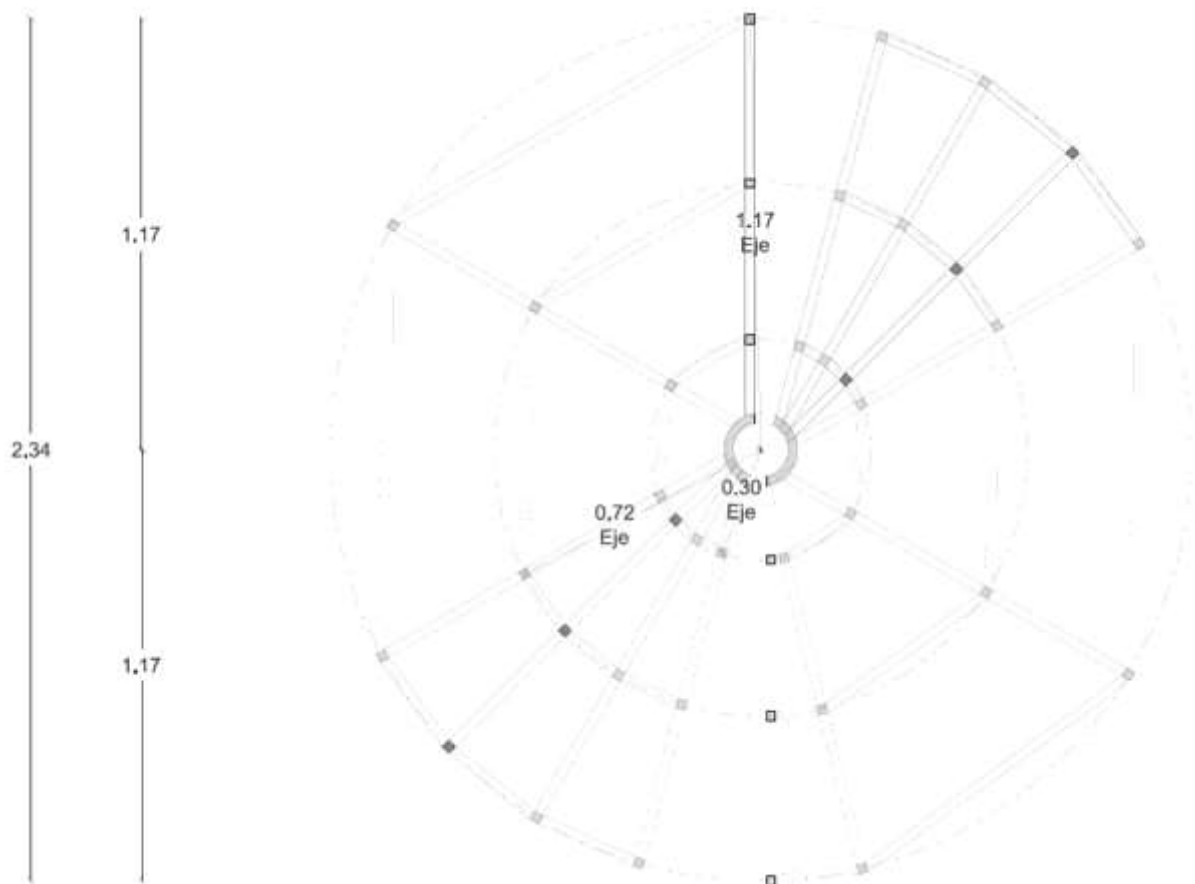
Dispositivo 3. Sumidero Sonar. Planta 2
